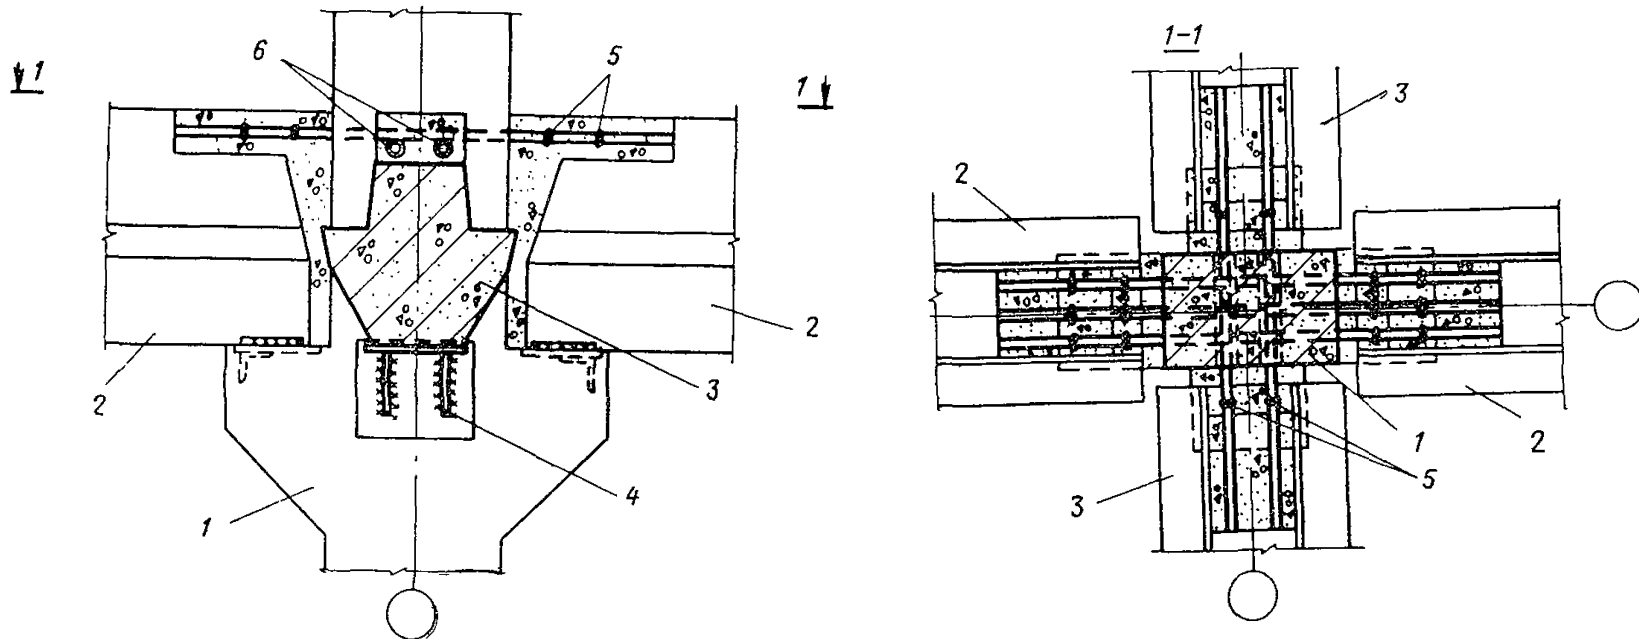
Консольное сопряжение сборных поперечных и продольных ригелей с колонной
